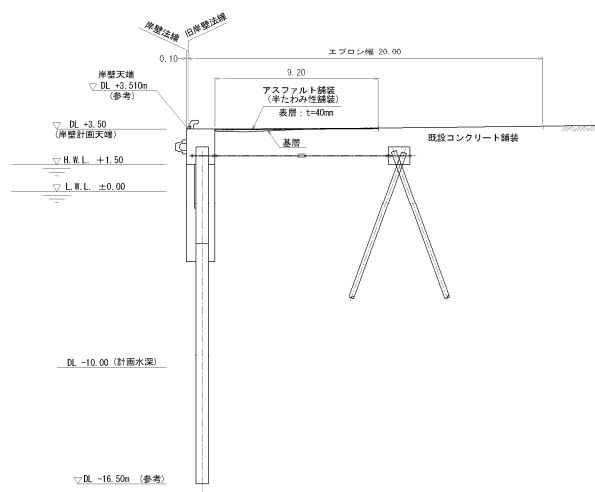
68 No. 1 南公共ふ頭 H 岸壁 (-10m) 断面図 (復旧後)
